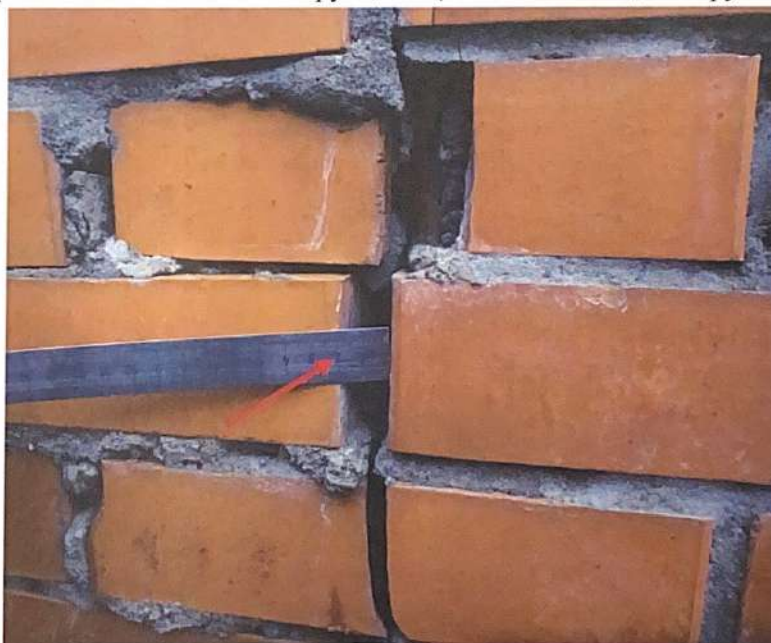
Секция 9. Фасад 1. Критическое повреждение наружной версты зоны примыкания металлоконструкций. Смещение отколовшейся части достигает 20мм.
